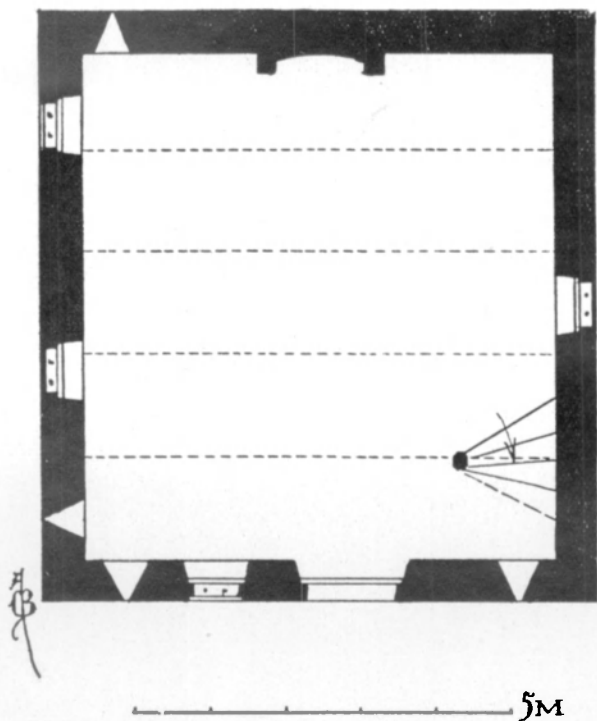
Fig. XL. — Refuge fortifié à Omal (1625). Plan du rez-de-chaussée.
